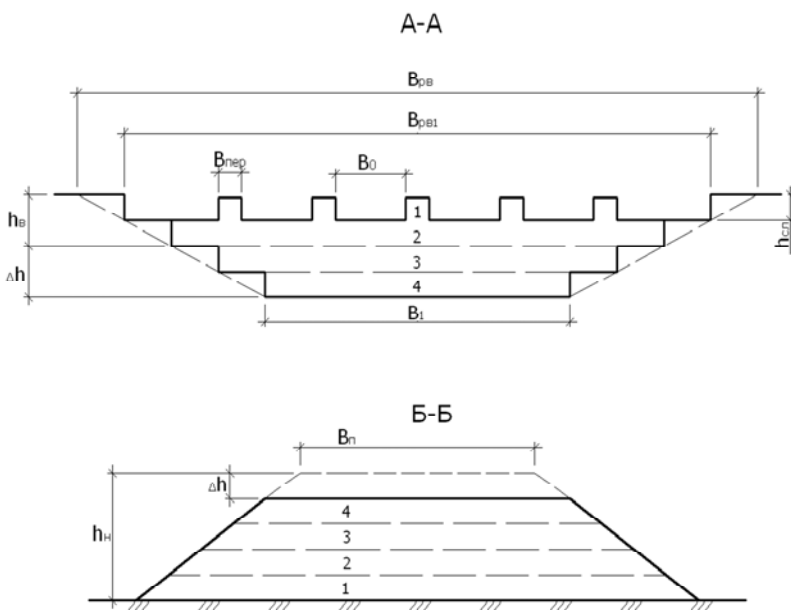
Схема разработки выемки и отсыпки насыпи бульдозером
